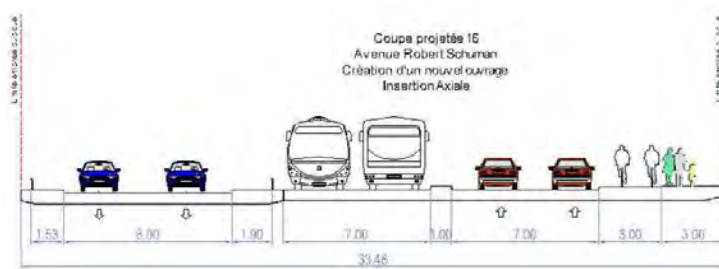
Coupe projetée sur le nouvel ouvrage de franchissement du Bd du Parc – Source : SYSTRA
